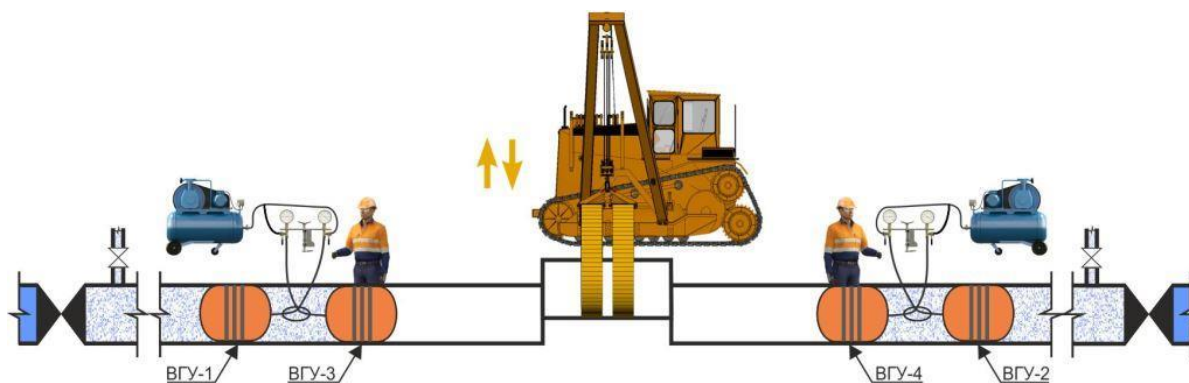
Сварочно-монтажные работы
